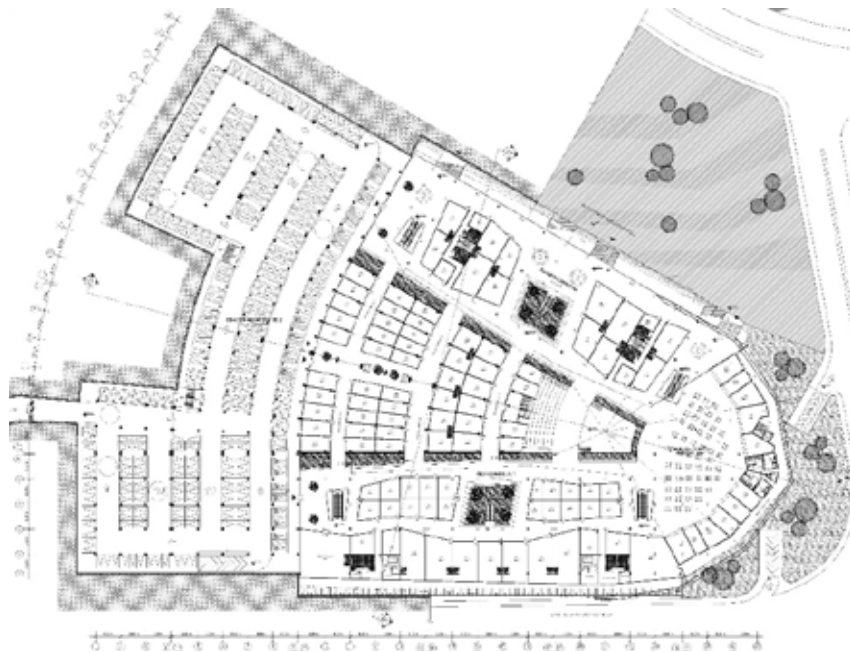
Planta de Semisótano. Nivel ±0.00 (2016)
